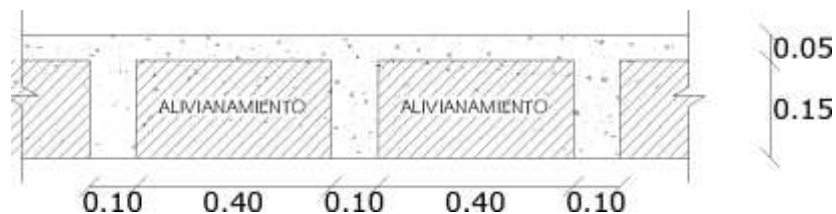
Dimensiones de la sección transversal de la losa aligerada. [Elaboración propia]
